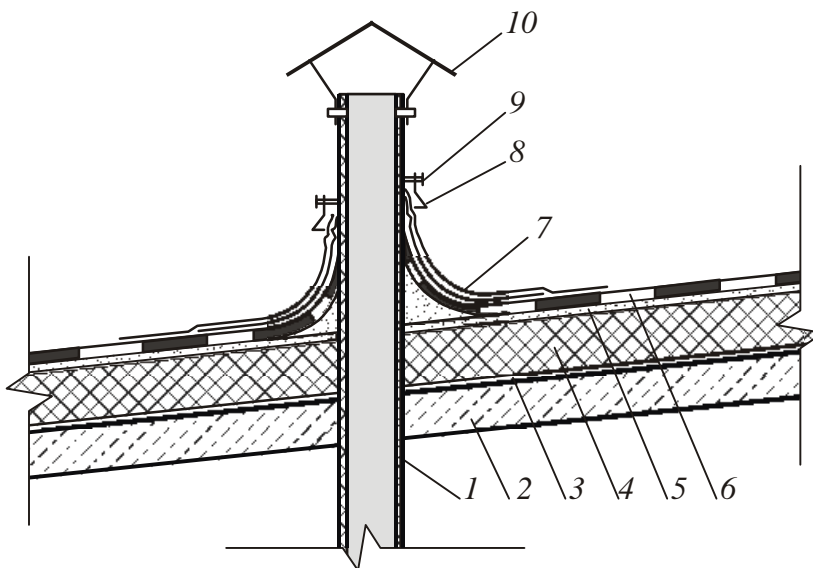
Ремонт примыкания кровельного покрытия к вытяжной трубе:
